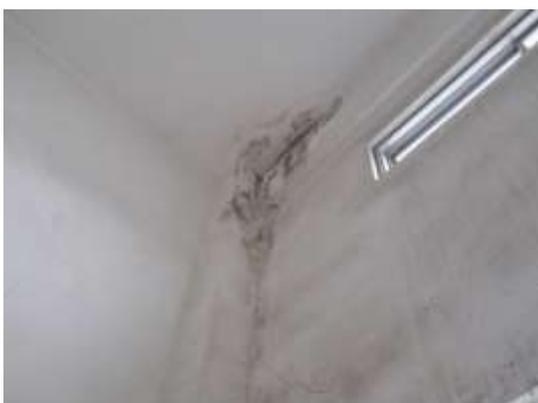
防水の劣化と躯体のひび割れ
